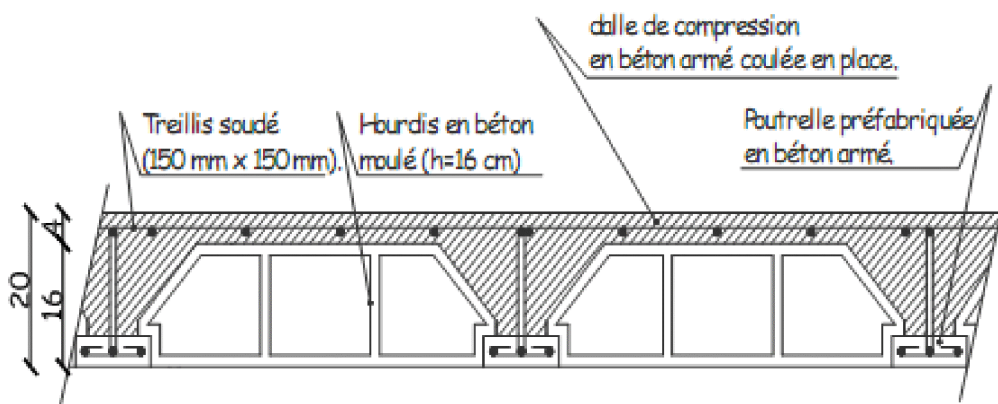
Schéma descriptif d'un plancher en corps creux.
